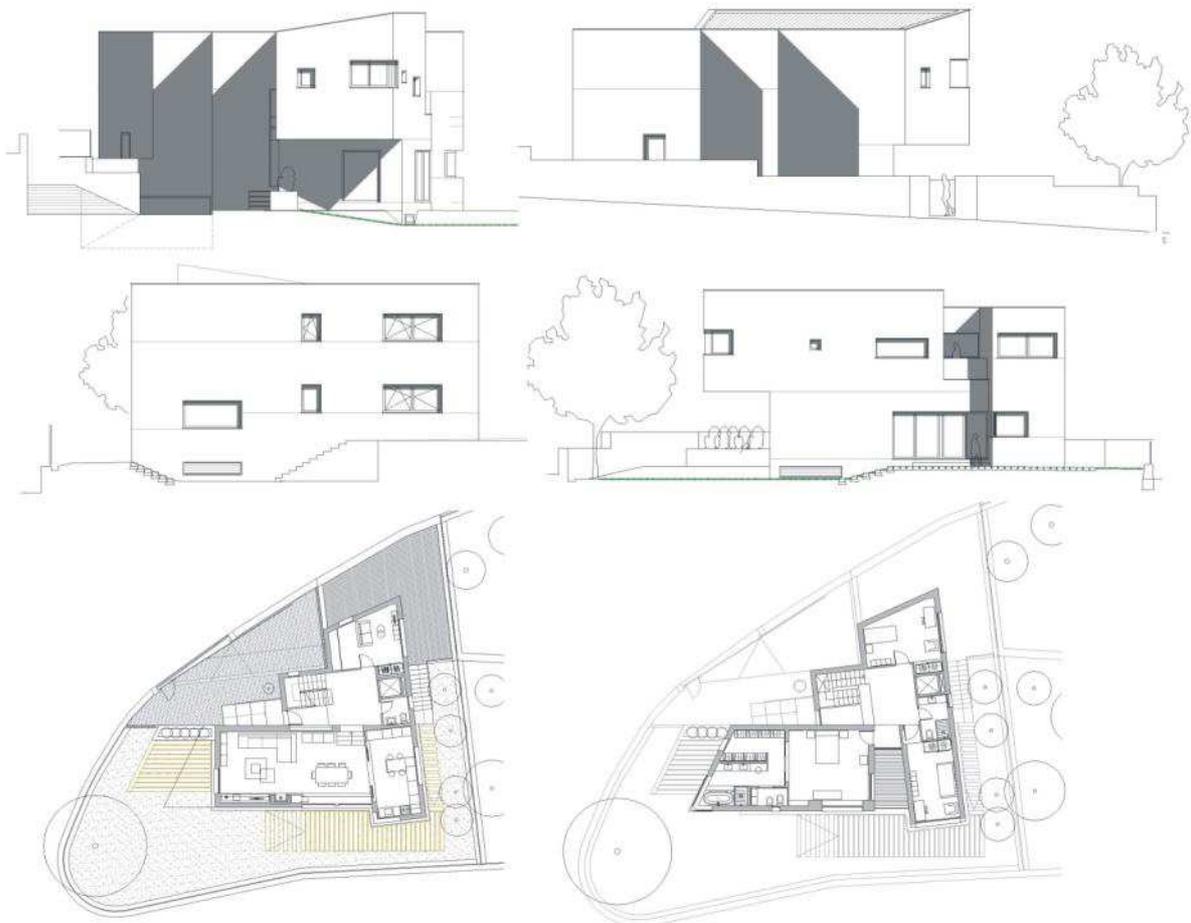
“Fachadas y plantas de la vivienda” Fuente: Autor.
